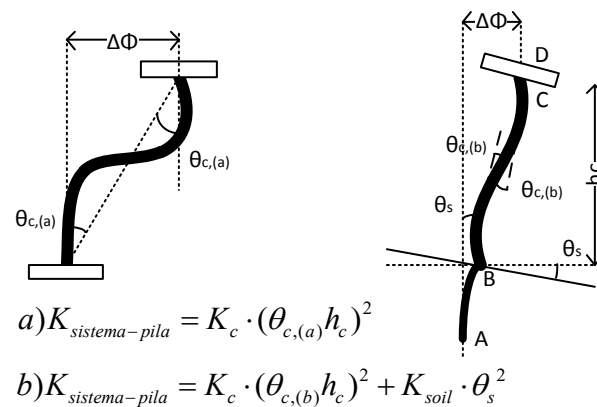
Subestructura de un puente pila-cimentación. a) Soporte empotrado b) Soporte flexible (Farantakis, Kotsoglou y Pantazopoulou 2014)
